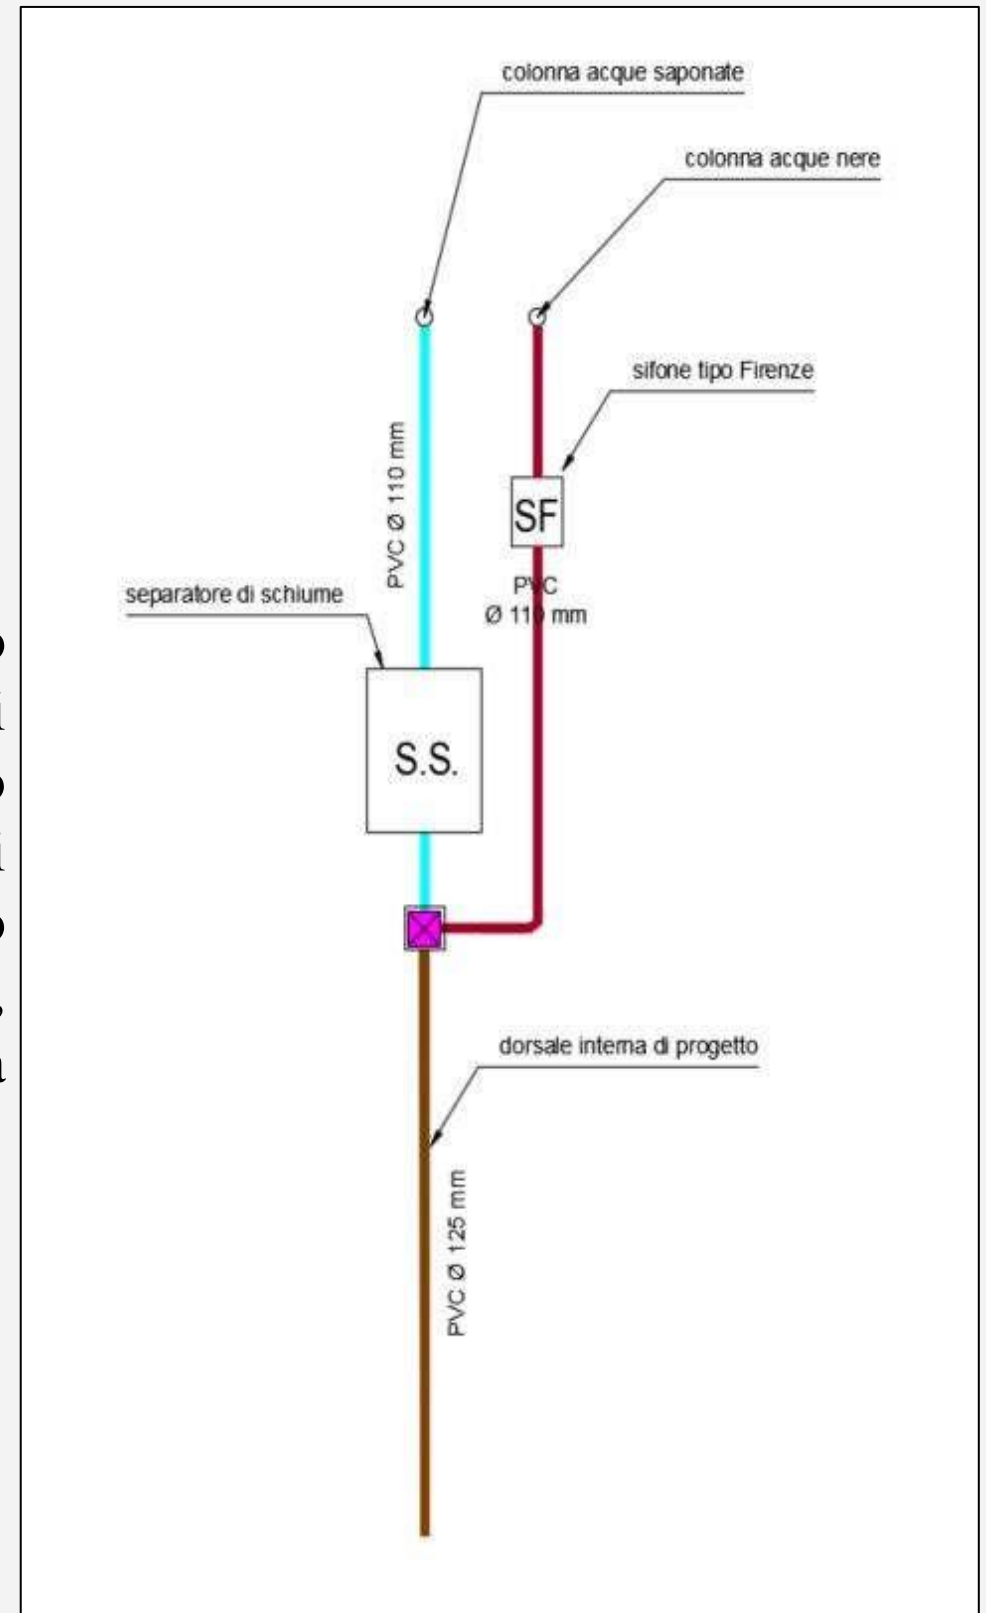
Rappresentazione planimetrica della rete acque reflue; estratto da “All. 05 – Tavola della rete acque nere e particolari costruttivi”.
